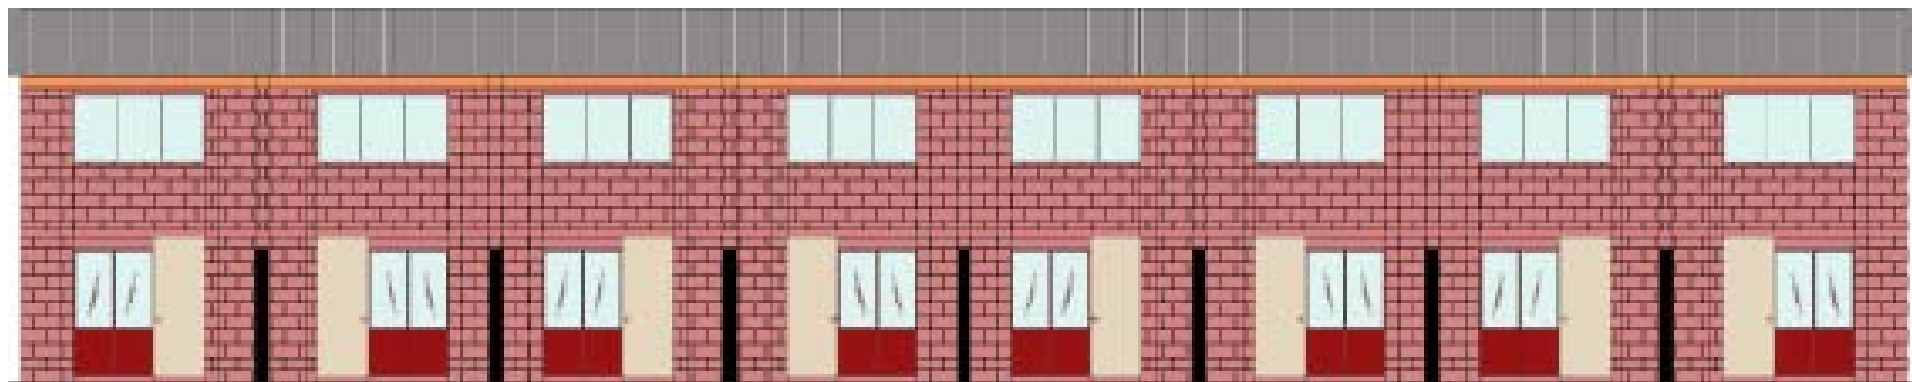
Elevación de un bloque completo. Compuestos de 8 viviendas en construcción continua.
